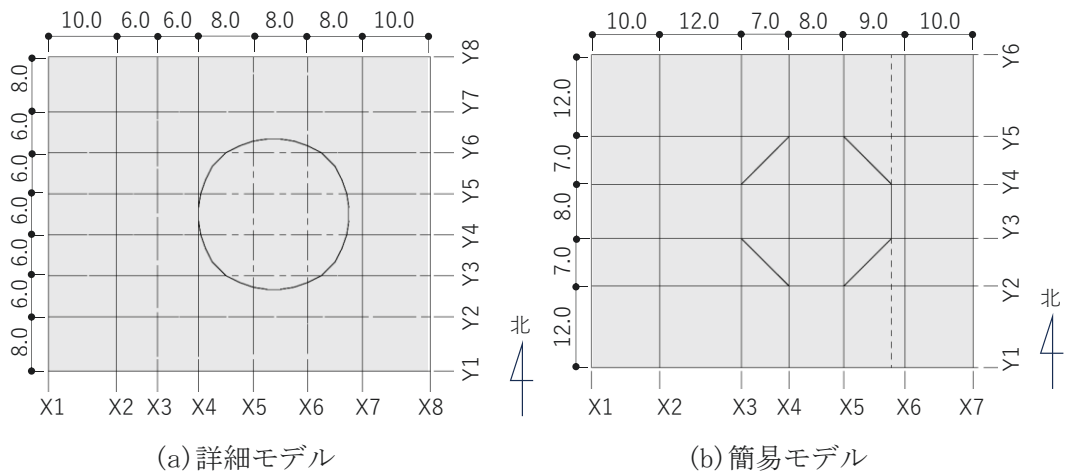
有限要素モデル地下1階平面（単位：m）
